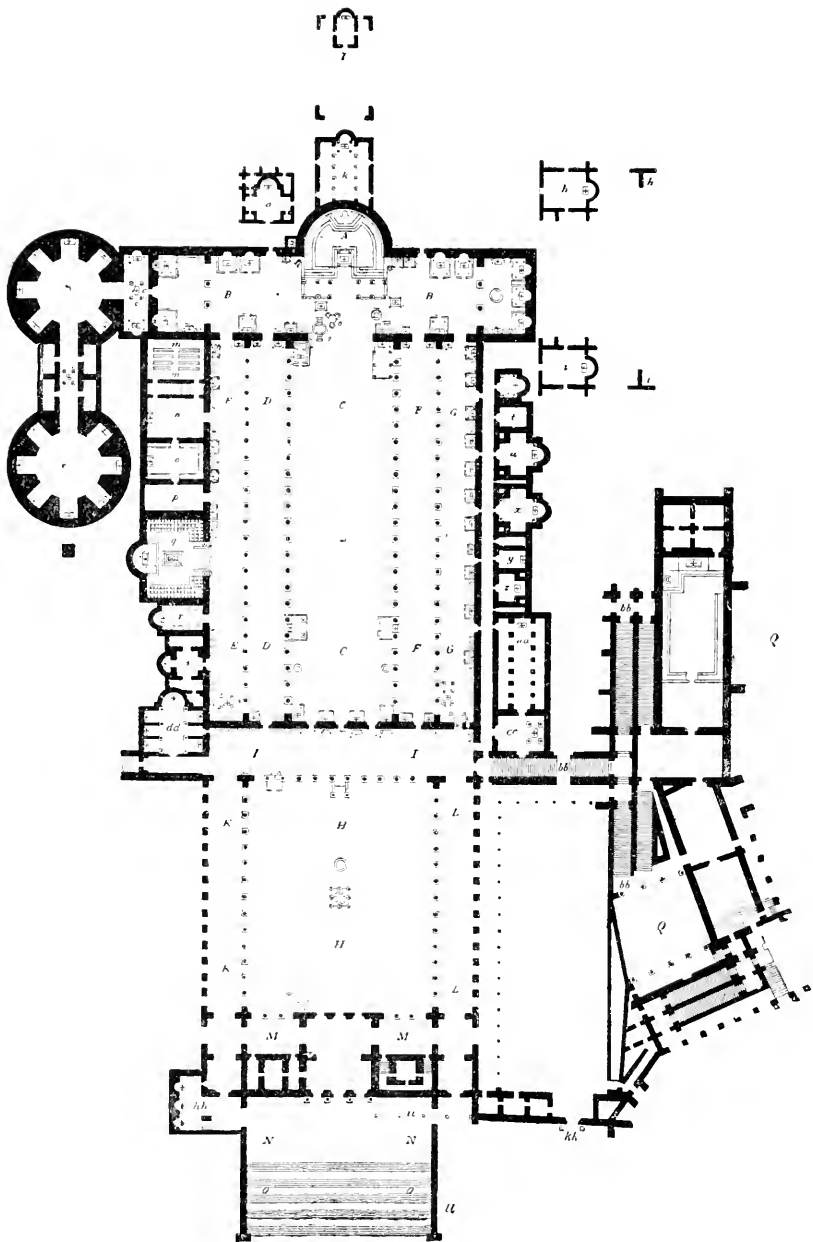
Grundriss der alten Petersbasilika zu Rom mit ihren Anbauten.
